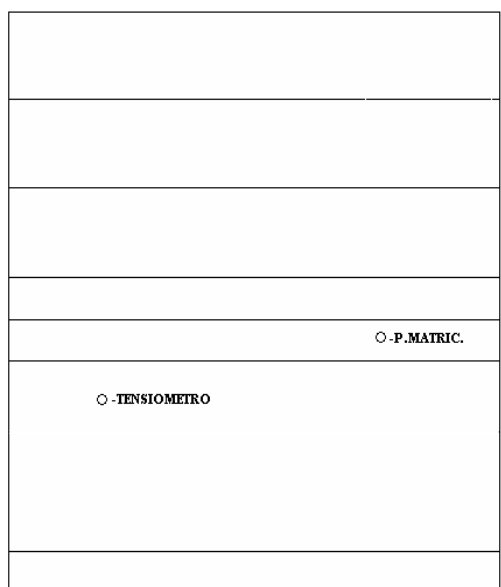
Sección en vertical del sistema de instrumentación de la sección II-4
